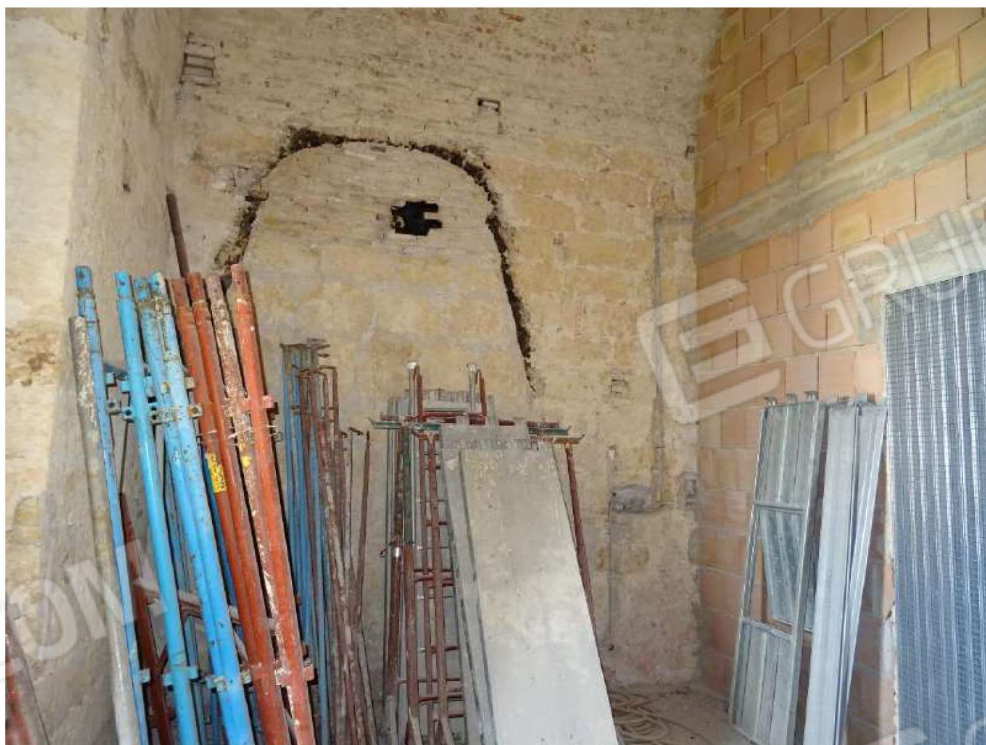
1° Stanza posta sulla destra dall'ingresso
